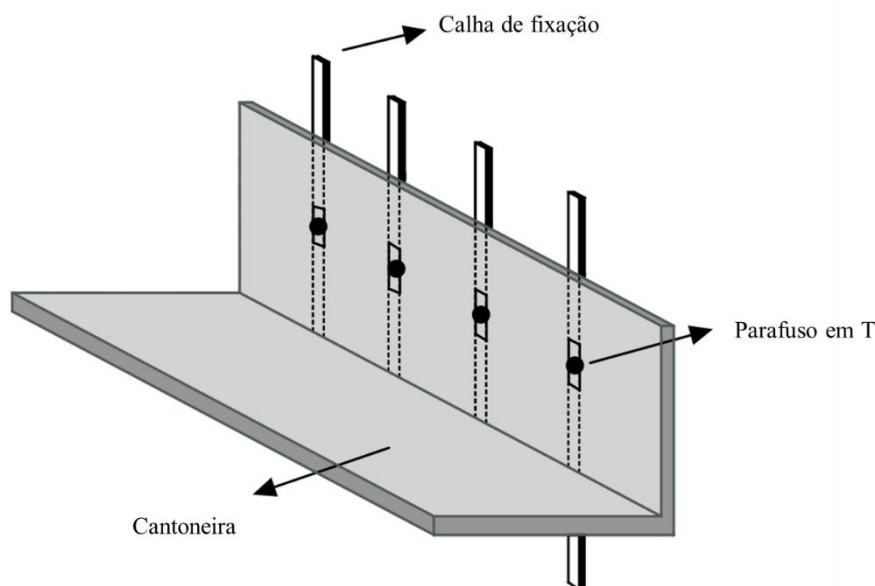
Solução de apoio Cast-in+Cantoneira, onde as Escadas Pré-fabricadas vão apoiar [121].
